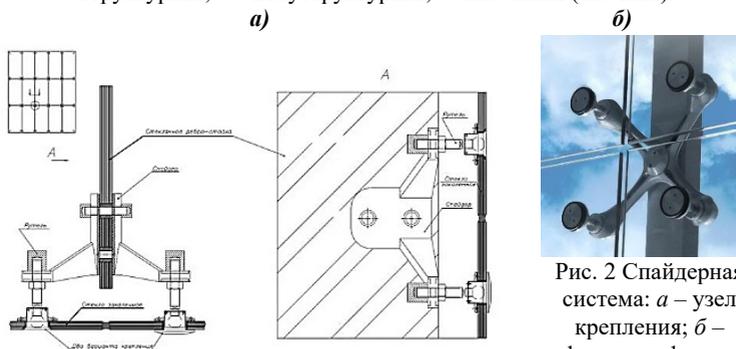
Спайдерная система: *а* – узел крепления; *б* – фрагмент фасада
